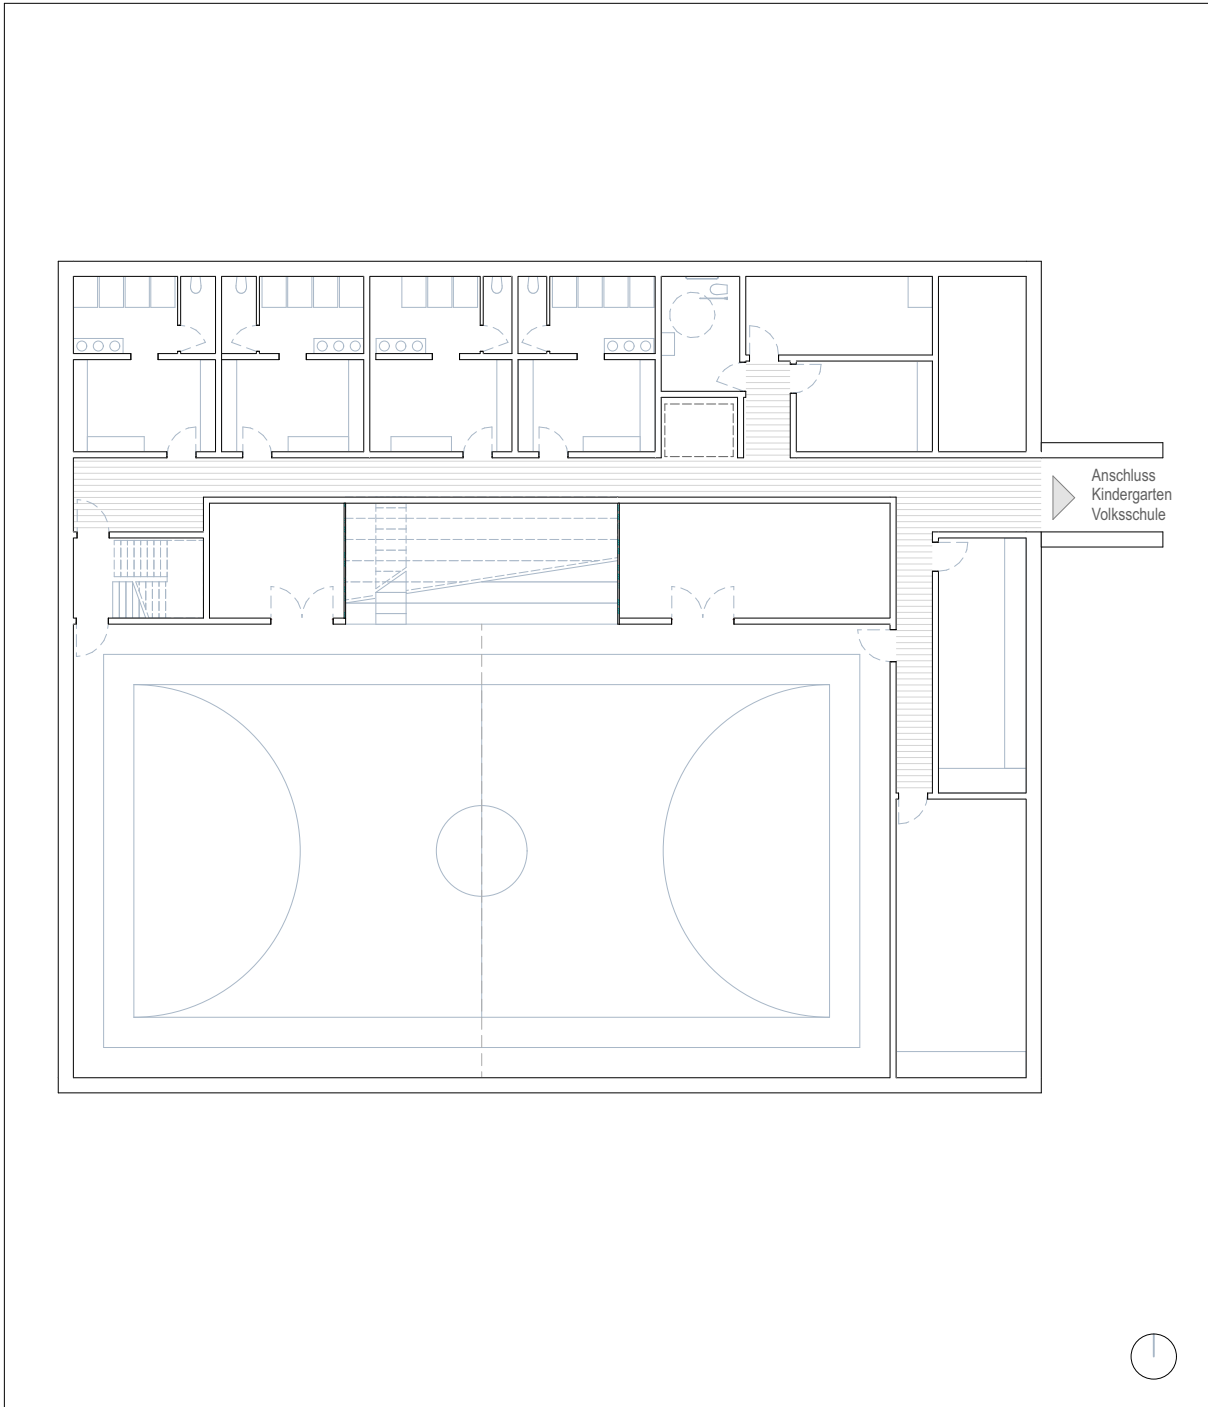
Grundriss KG Veranstaltungshalle
